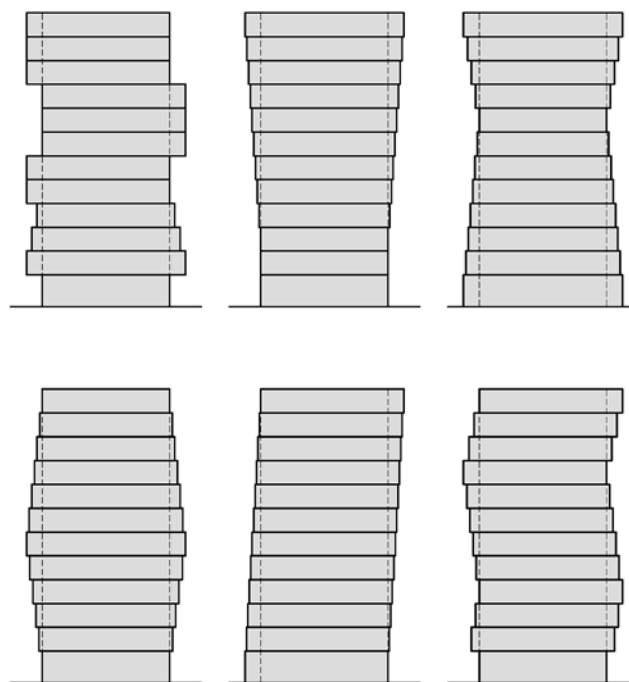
Возможные профили панельных, каркасных и панельно-каркасных зданий (пунктиром отмечен несущий скелет здания)
